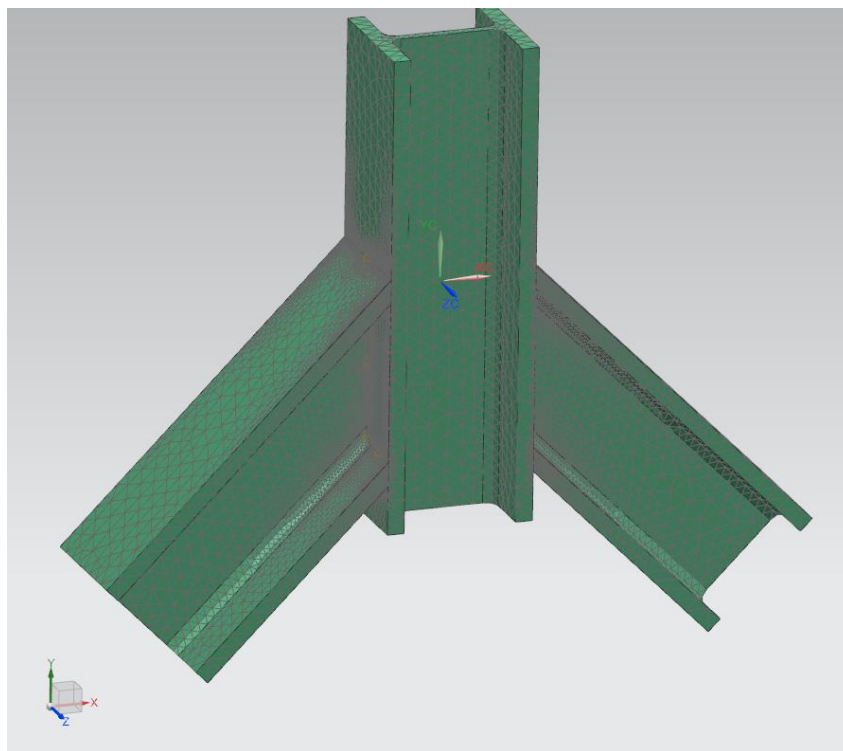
zobrazení 3D geometrie řešeného uzlu
